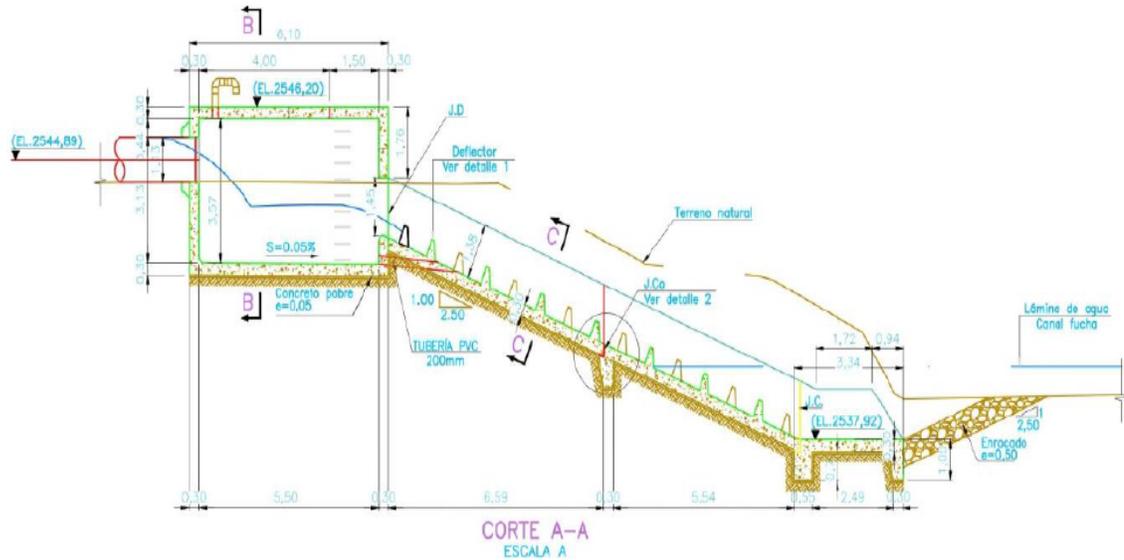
Plano en planta longitudinal de la estructura de descarga sobre el CER del río Fucha. Fuente: Radicado EAB ESP No. 2016ER58931.
